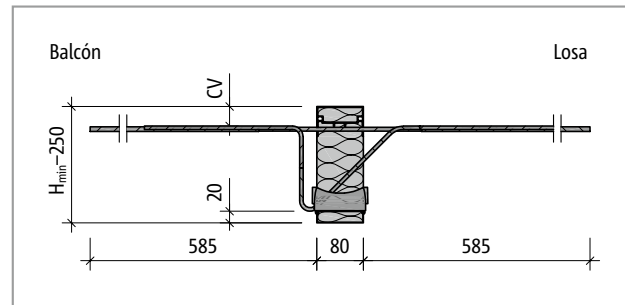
Schöck Isokorb® T tipo K-M5 y K-M6 en R0: Sección del producto
